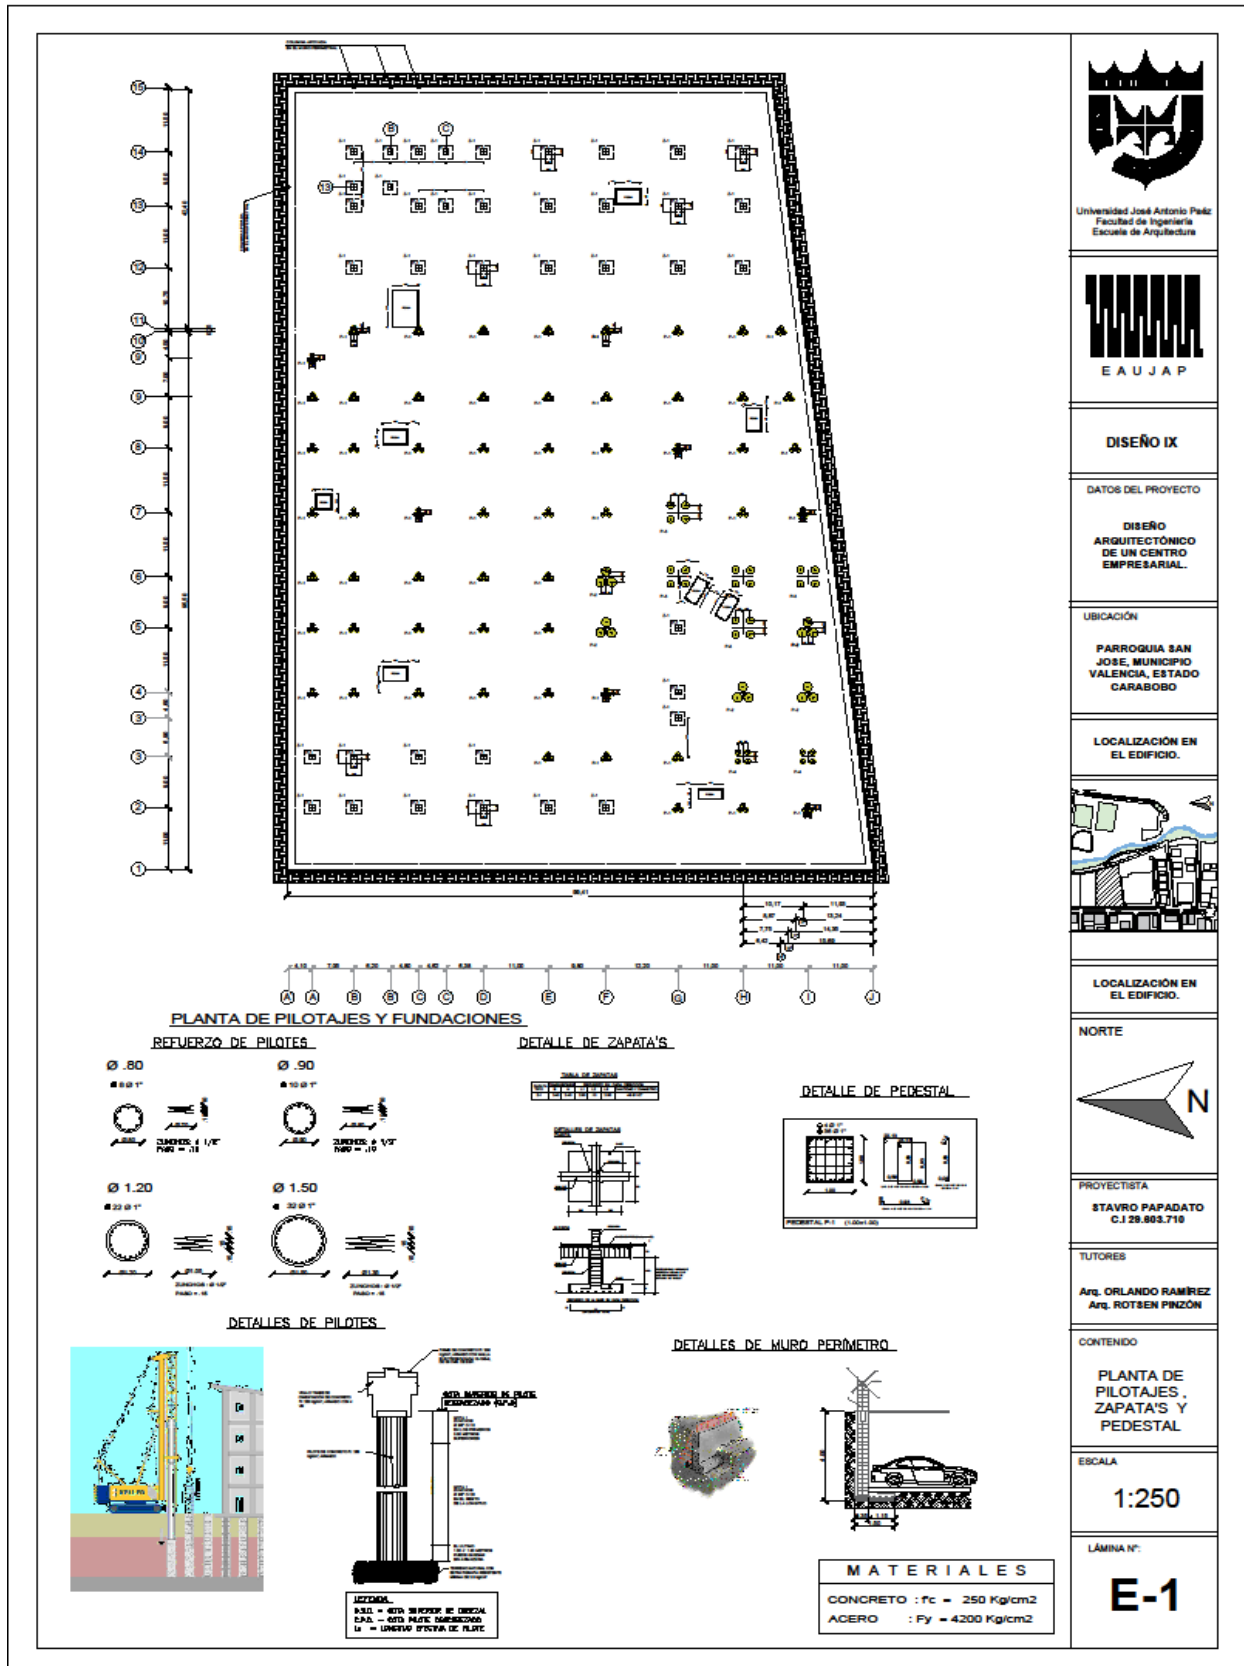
El Planta de Pilotajes, Zapatas y Pedestal Fuente: El Autor (2023)
